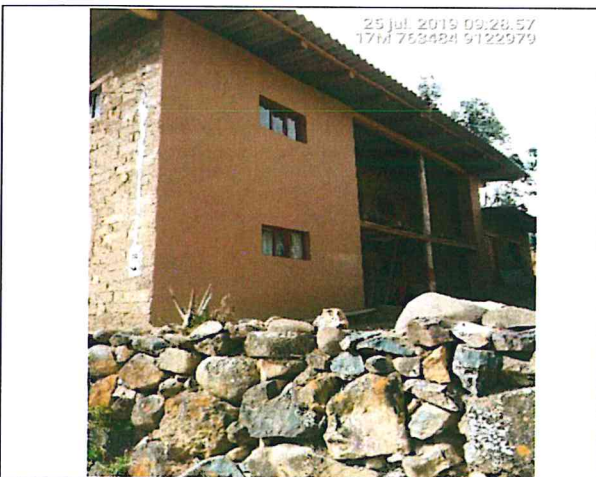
Vivienda de adobe en buen estado con techo de calamina.
